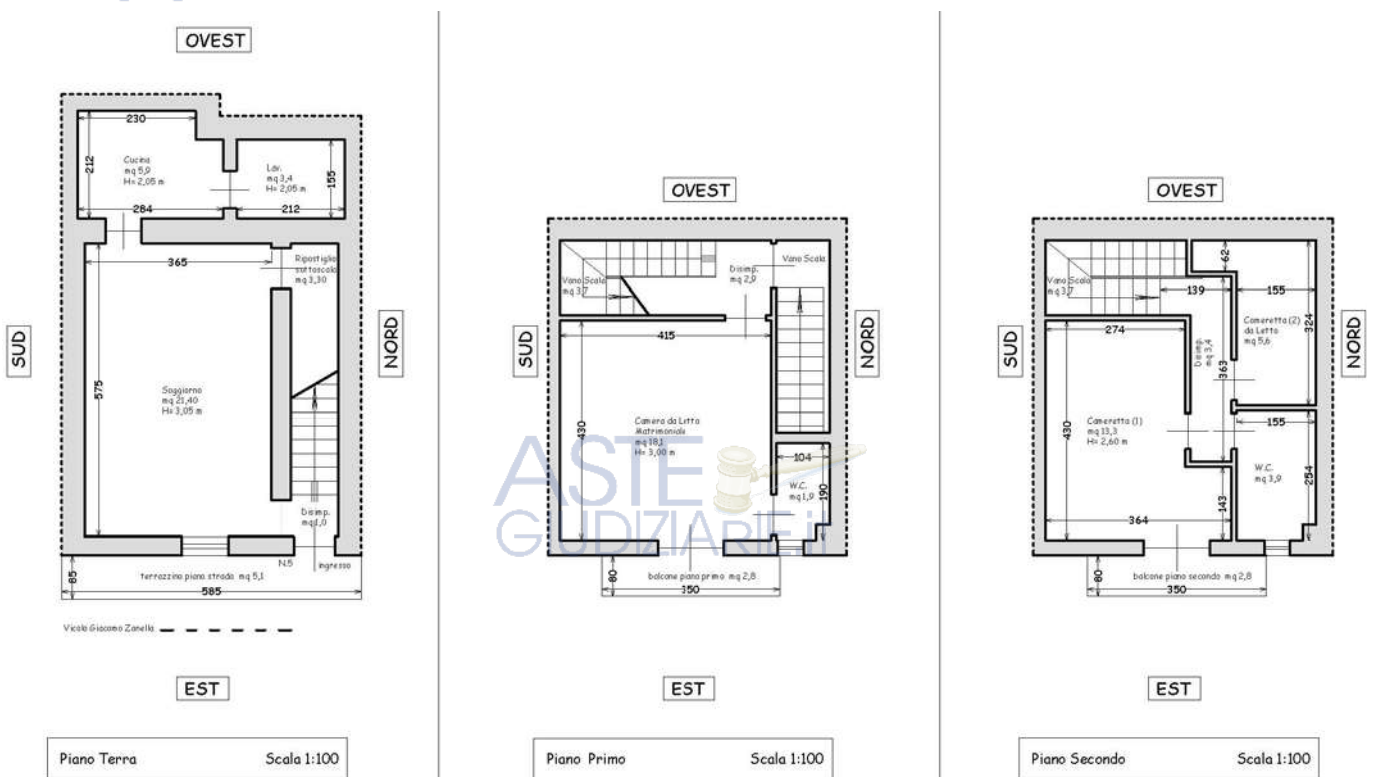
Stralcio planimetria di rilievo (Immobile piano terra, primo e secondo Fig. 69, part. 13233, sub. 1)
